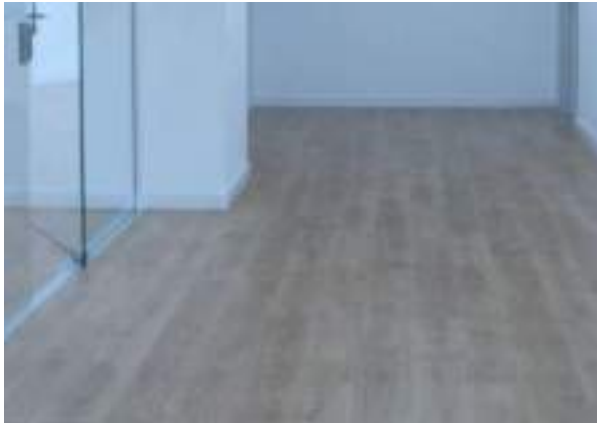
Pavimento de parquet en la sala P0-1.02
